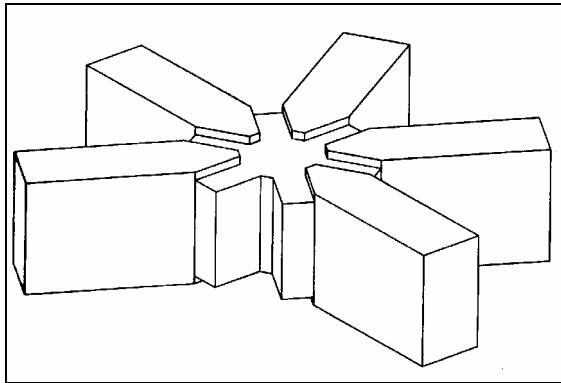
Laschenknoten – Geschweißt [SSK04]
